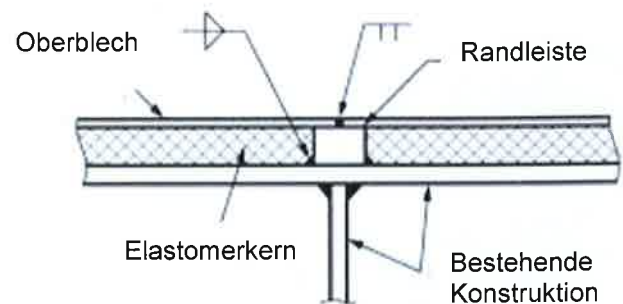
Abschluss einer Kavität durch aufgeschweißte Randleisten, die gleichzeitig Unterlage für den Schweißstoß der Oberbleche sind
